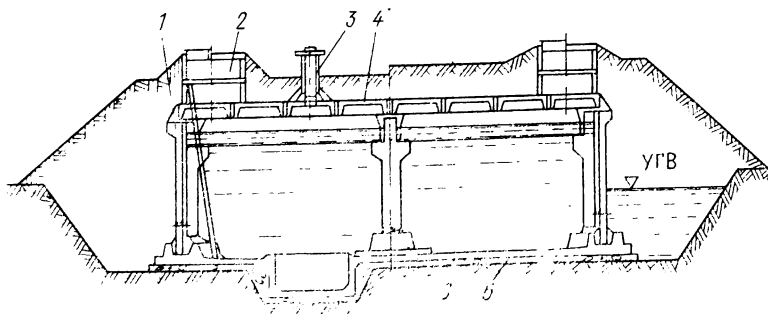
Сборно-монолитный железобетонный пожарный резервуар
